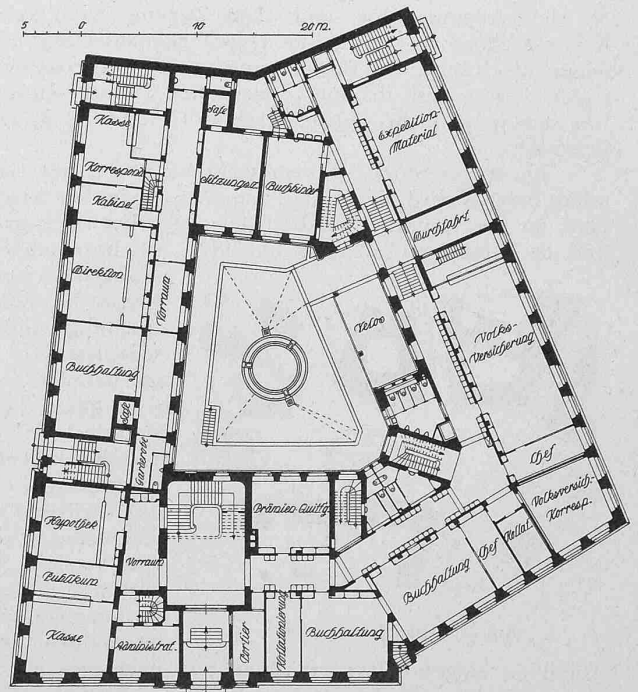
Grundriss vom Erdgeschoss. — 1:600.
